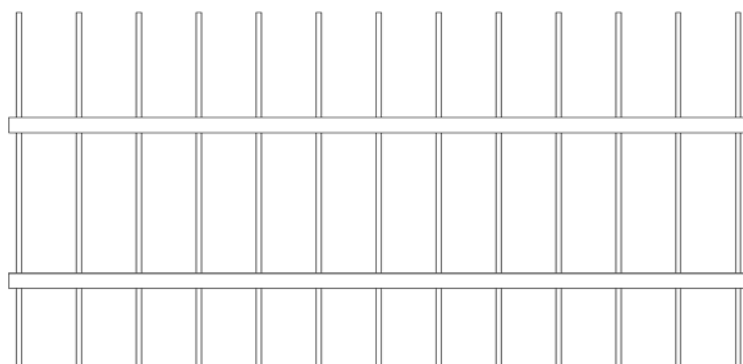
Vista en planta de las vigas longitudinales y transversales. Elaboración propia con AutoCAD
